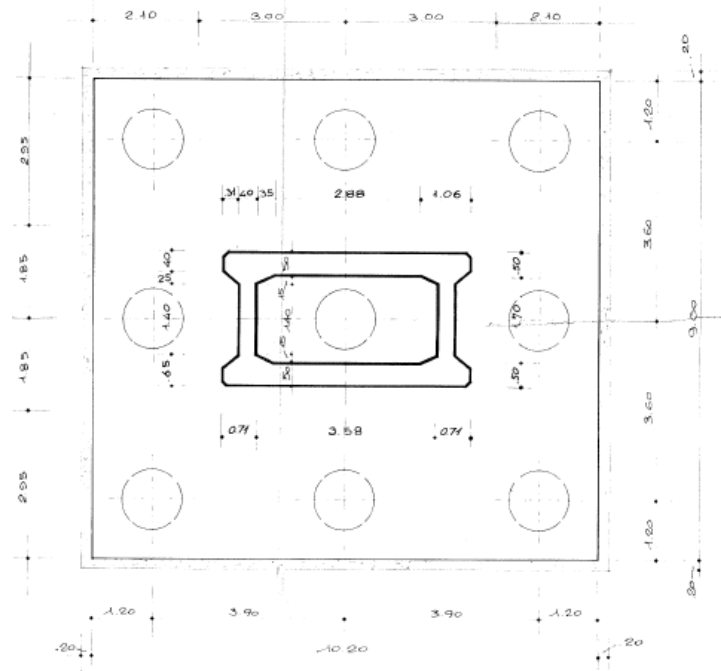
Pianta della fondazione con indicazione dei pali, 9 pali
